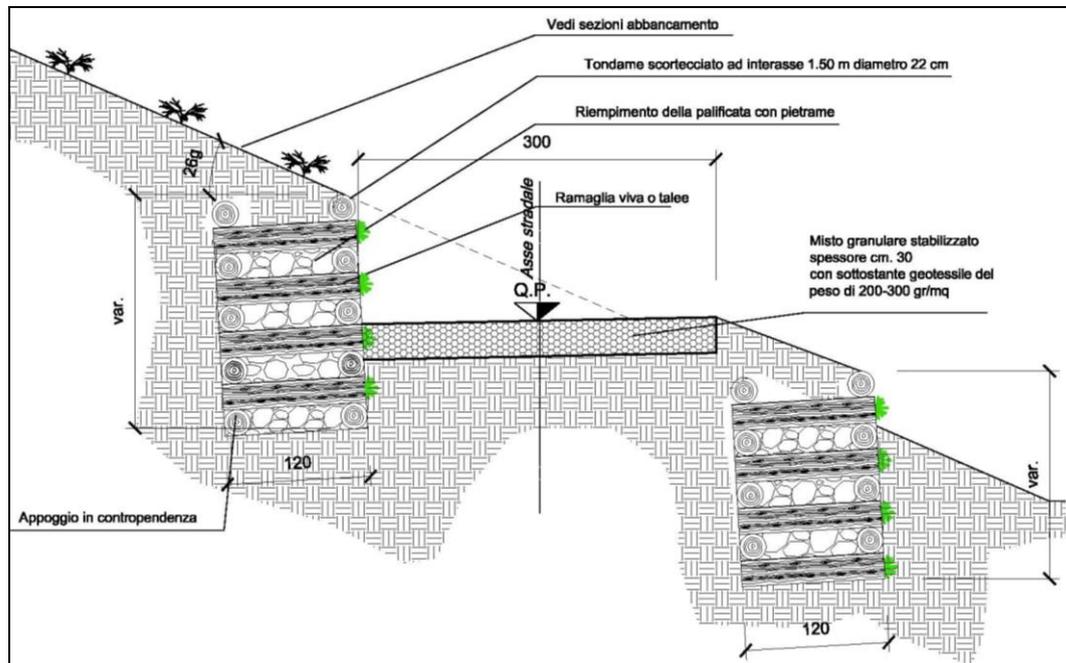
Viabilità pista lungo le banche – Sezione tipo
